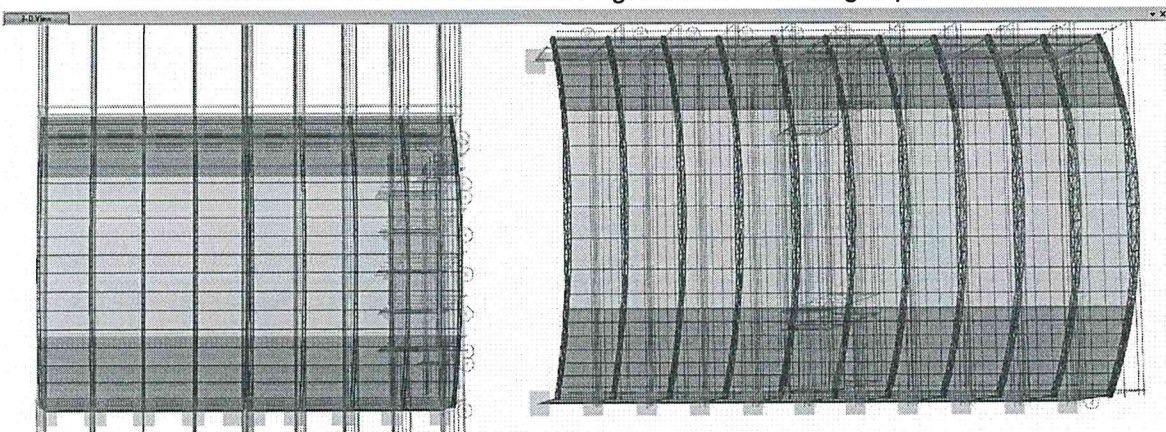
Vista general del modelo estructural de la Edificación 19-20 sistémico analizado. Los elementos no estructurales fueron ingresados como cargas permanentes
